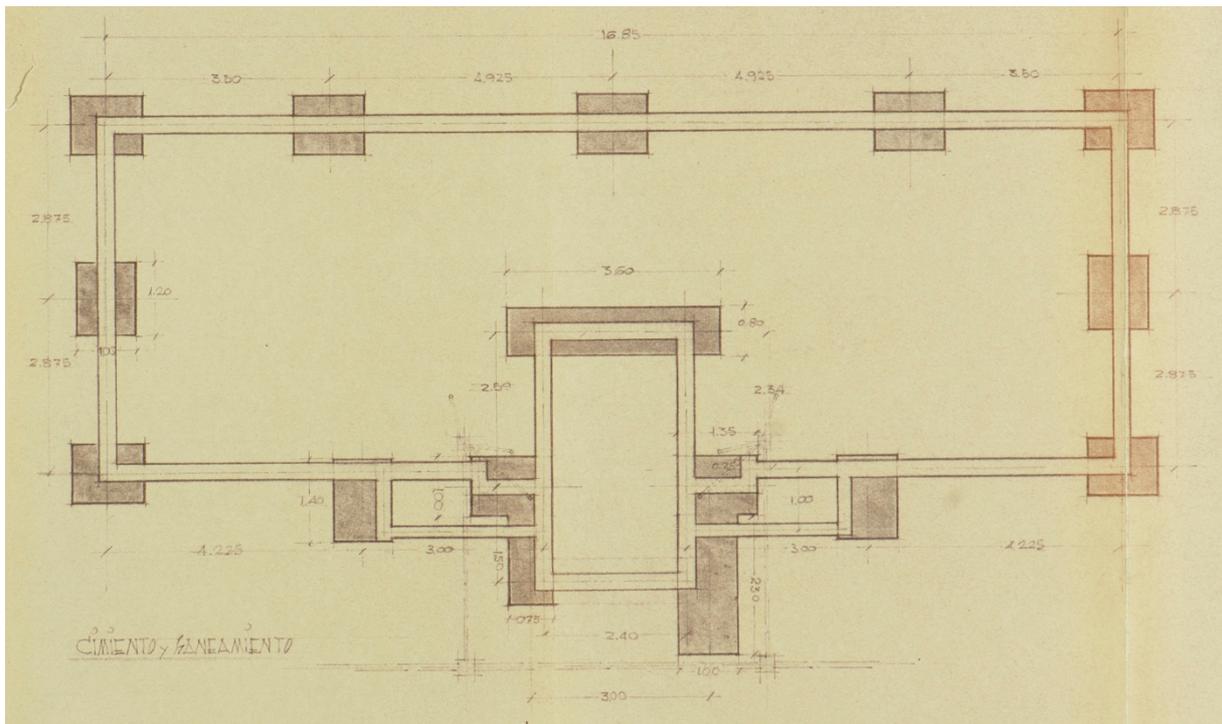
Cimentación bloque lineal. ICAS-SAHP, Archivo Municipal de Sevilla, Obras de Particulares
